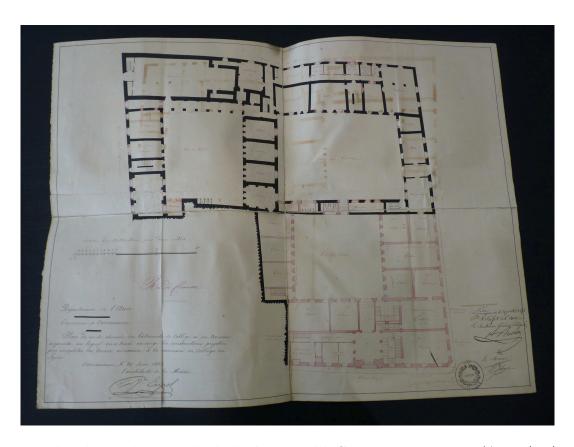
Plan du rez-de-chaussée du lycée de Bourg-en-Bresse en 1861 (AN F/17\*/2534)
